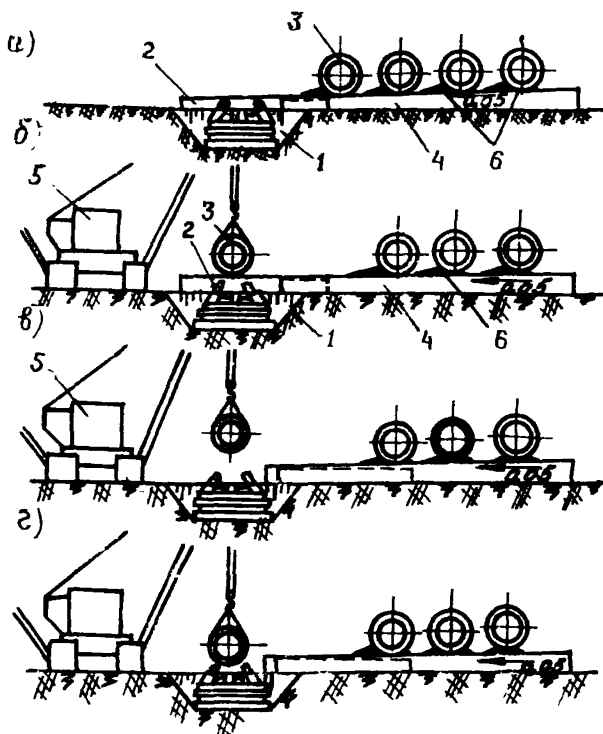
Схема подачи плети трубопровода на роликовую спусковую дорожку:
